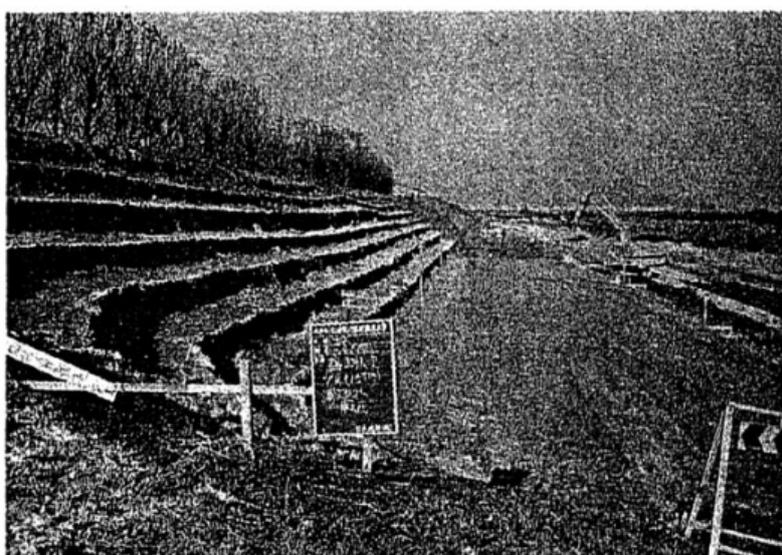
拡築部の施工状況（近畿地方整備局）
